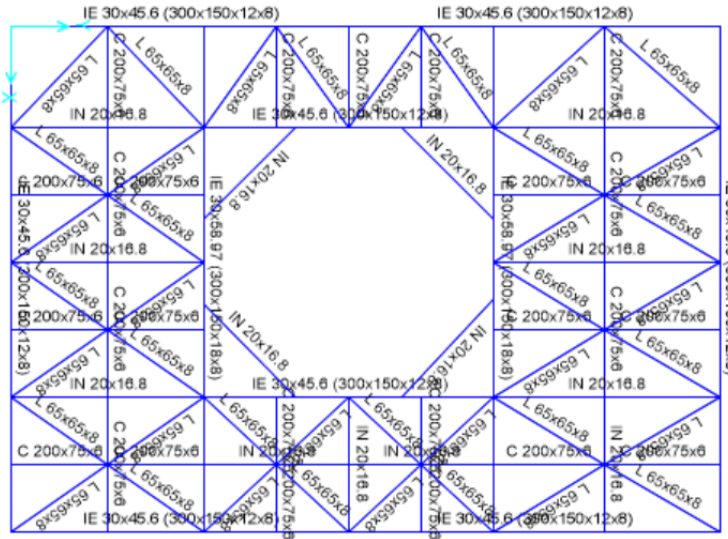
Vista en planta 1.75 [m] sobre nivel de terreno.
